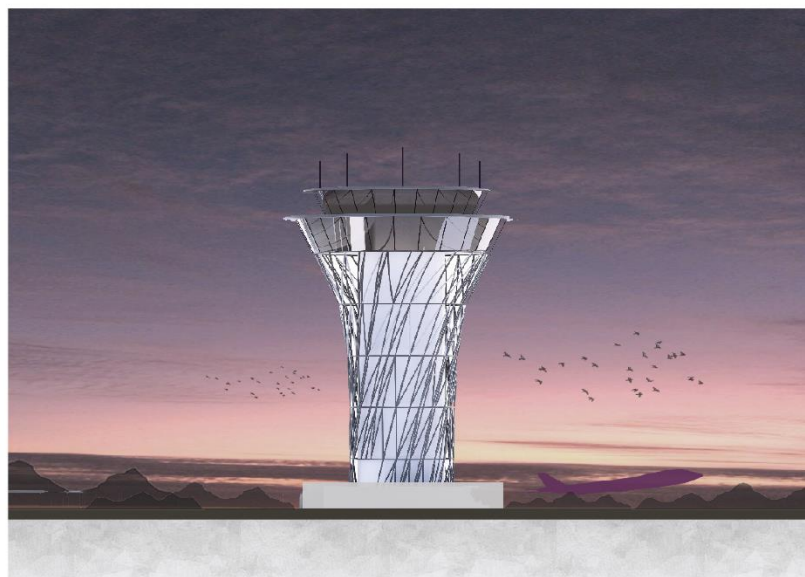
10 Tampak Kanan Air Traffic Control Tower
